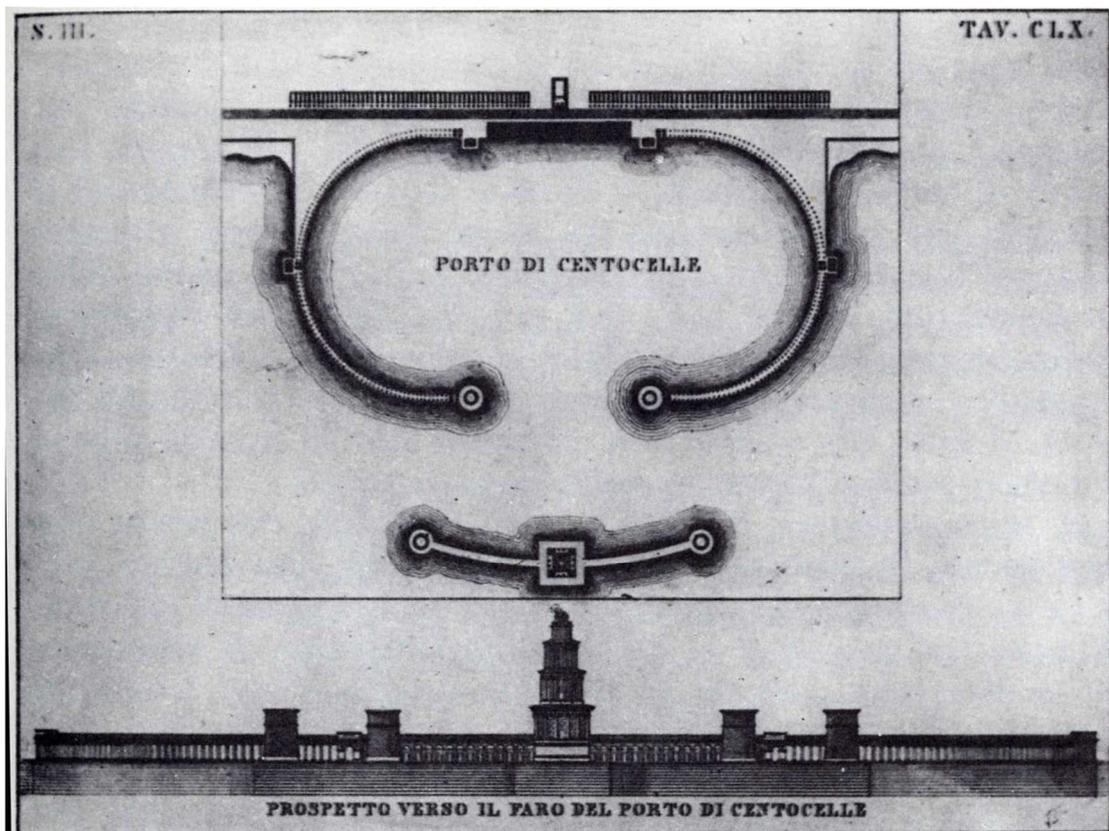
Luigi Canina. Pianta e prospetto del porto di Centocelle (1836).
